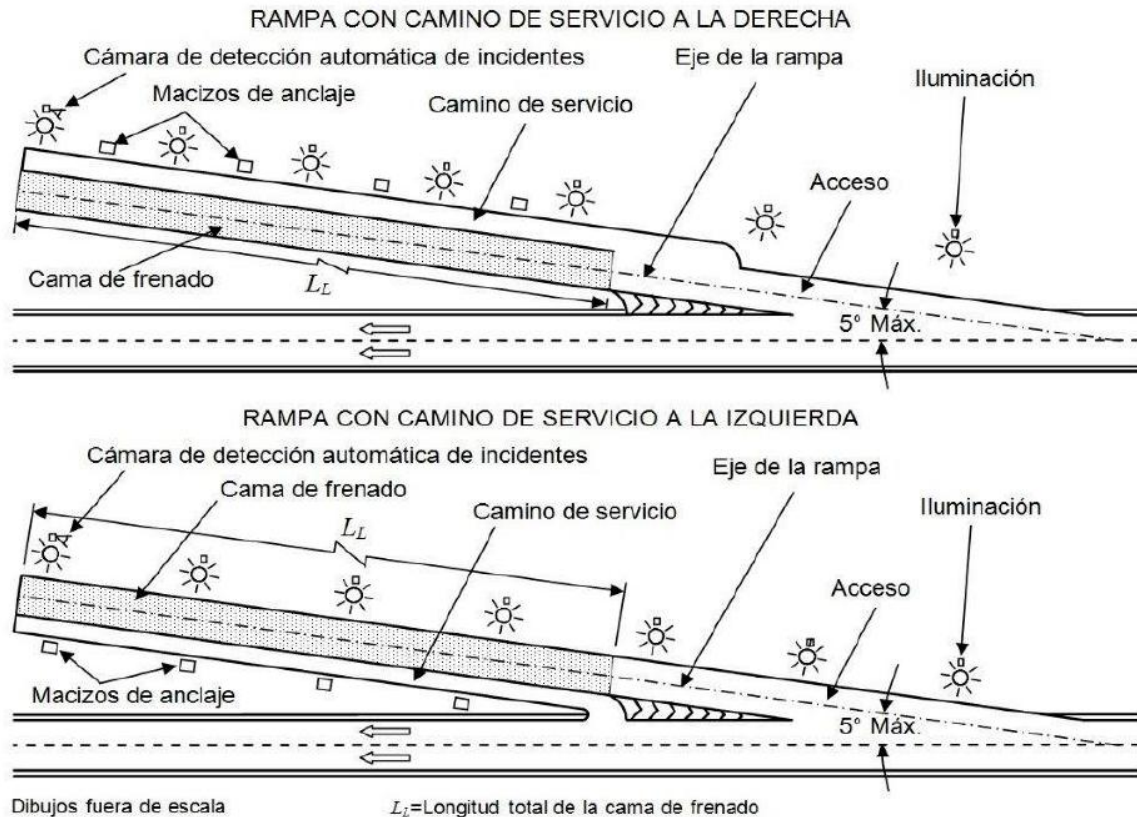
Rampa de emergencia para frenado. Esquema de disposición en planta
